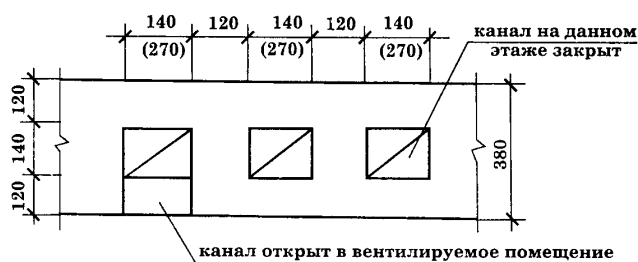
Размещение вентиляционных каналов во внутренних стенах.
